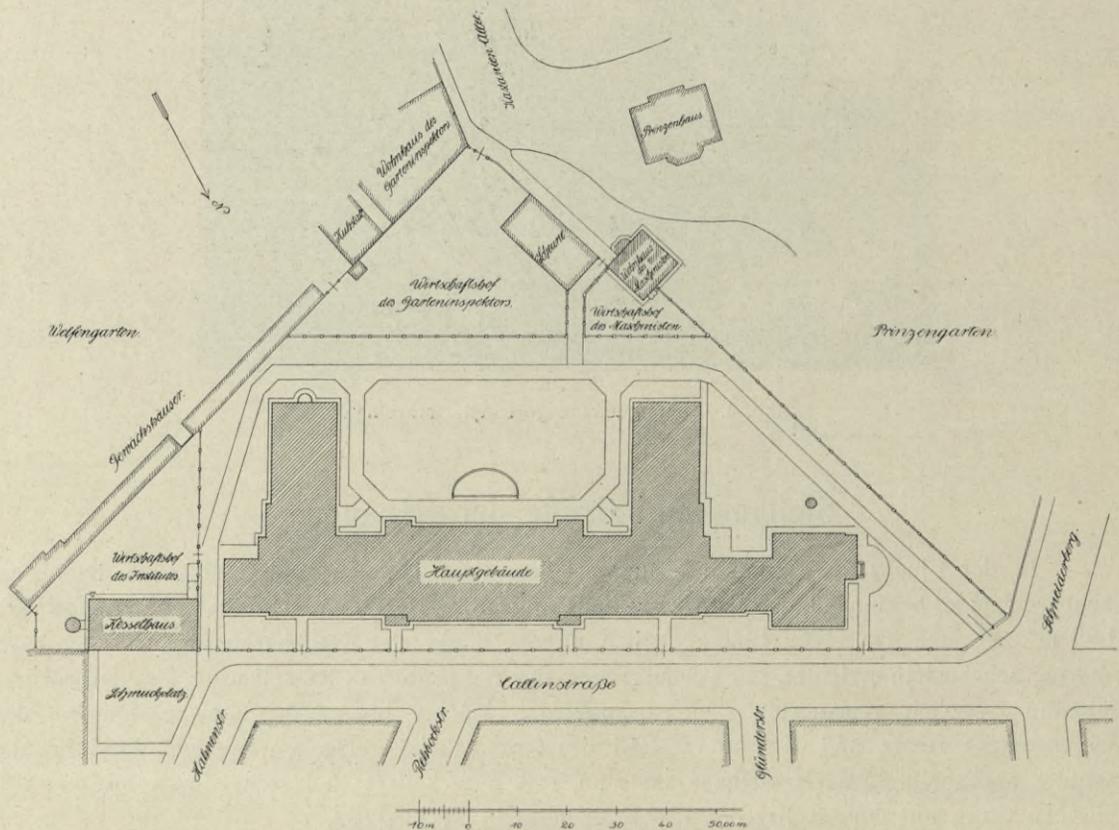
Lageplan des Grundstückes mit Gebäuden und Straßen.
